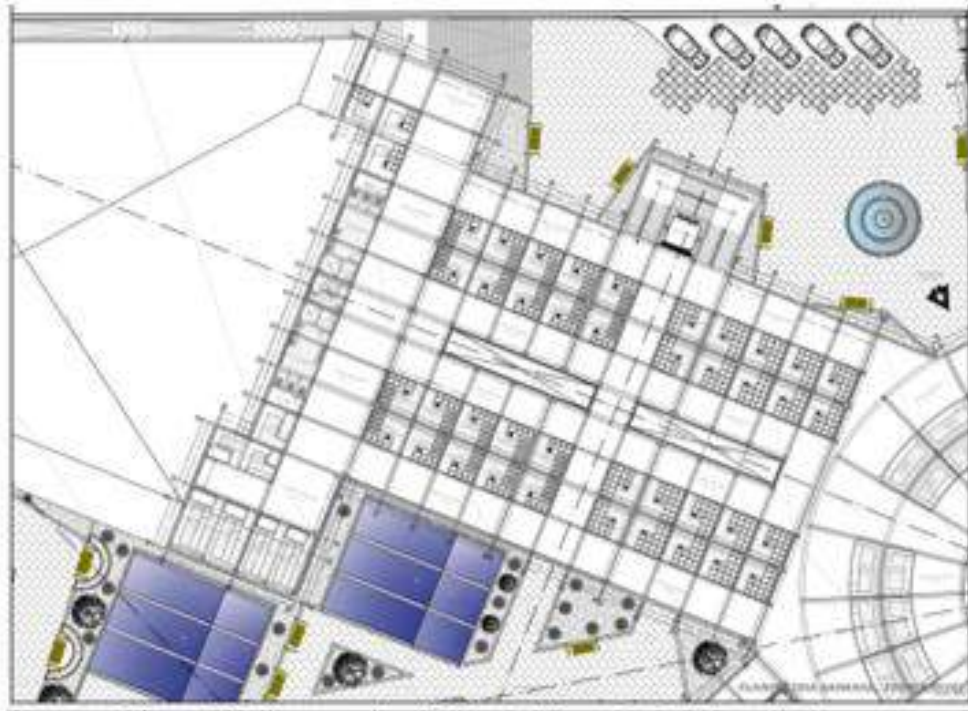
Plano arquitectónico de bloque A y B Segundo piso
